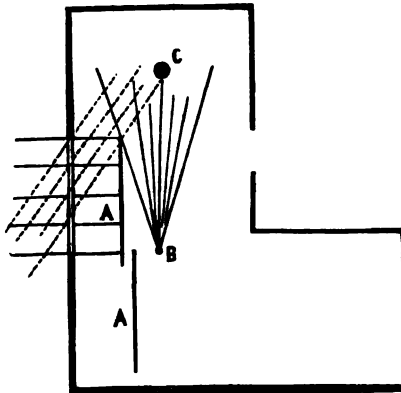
Grundriss des Südfront-Ateliers.
